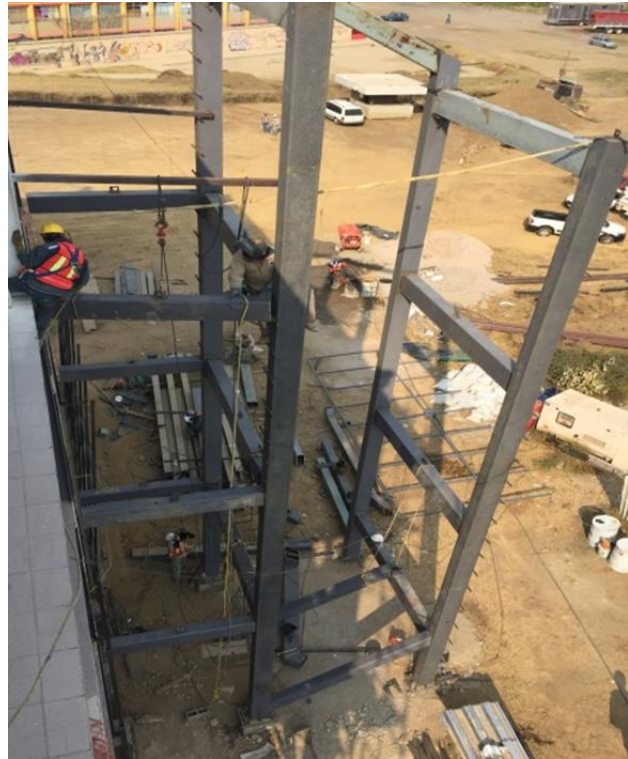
Montaje de estructura metálica para la escalera de emergencia.
